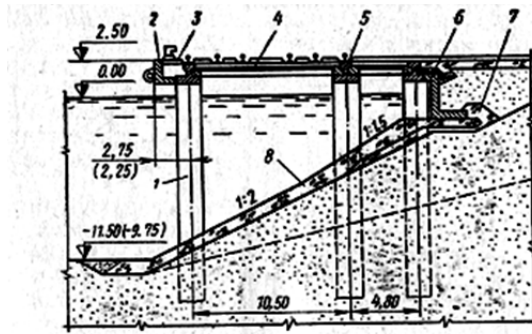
Схема збірної причалу на залізобетонних оболонках:
